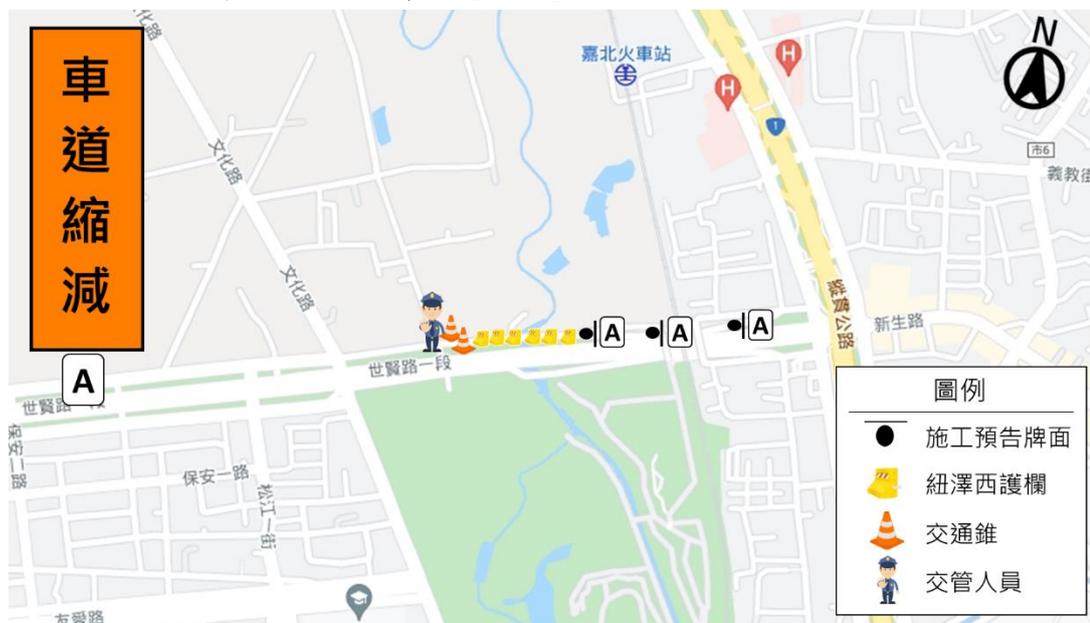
世賢路一段施工期間相關施工告示牌位置示意圖
